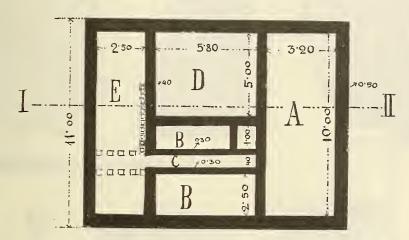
Grundriss einer römischen Hausruine in Novi Šeher (1:200).
